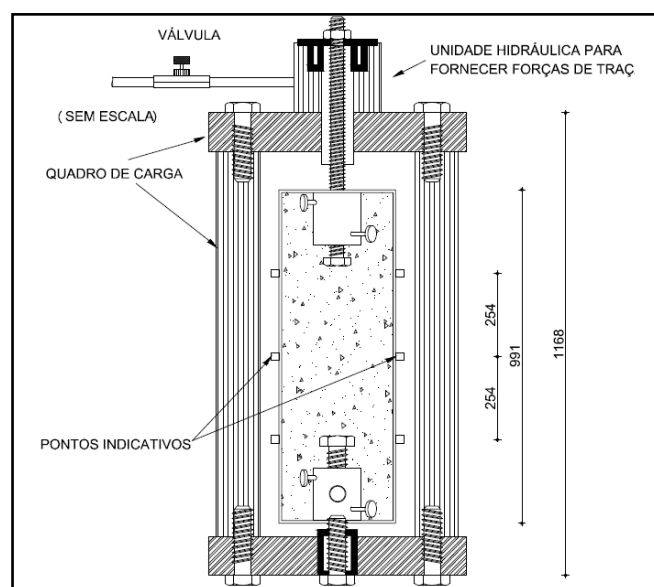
Descrição esquemática de um ensaio longitudinal activo (Adaptado de [193])
